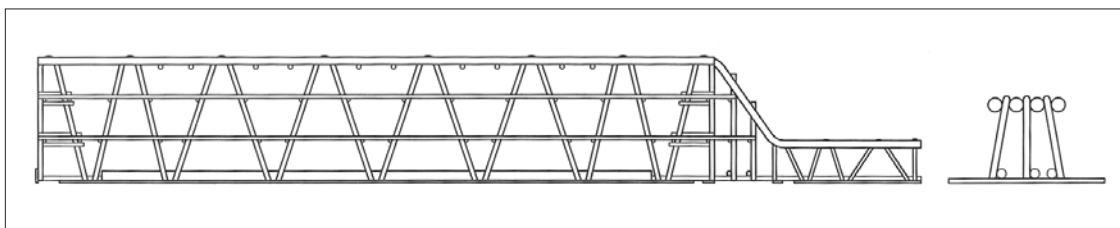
Vista laterale trave+sbalzo e sezione trasversale sbalzo con fondello in acciaio.
